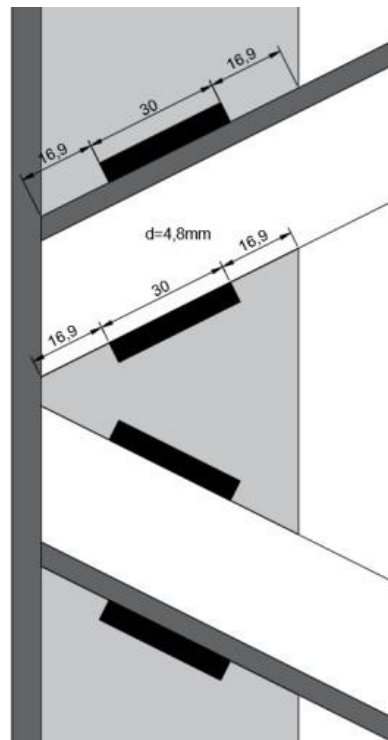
Detalle de unión de barras de celosía de la columna metálica
